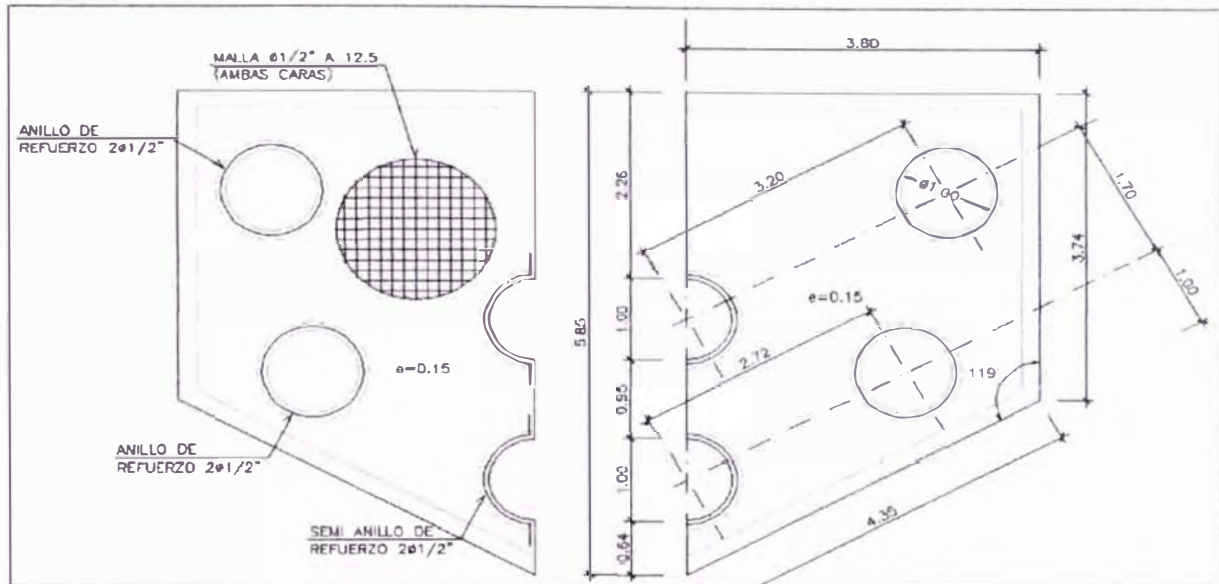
Planta de plataforma prefabricada con espacios para los pilotes
